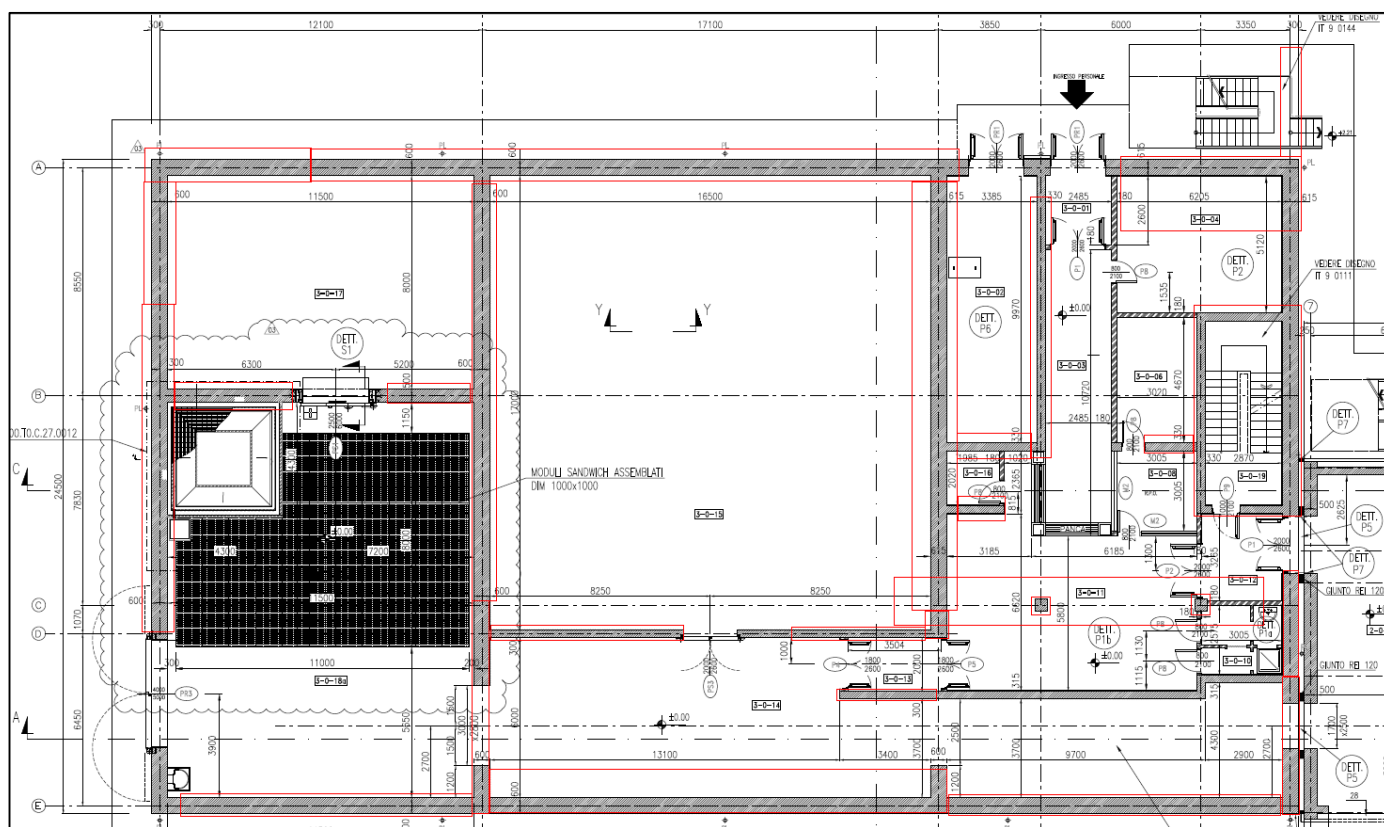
/1 – Planimetria di progetto con indicazione (in rosso) delle strutture in elevazione ad oggi realizzate
